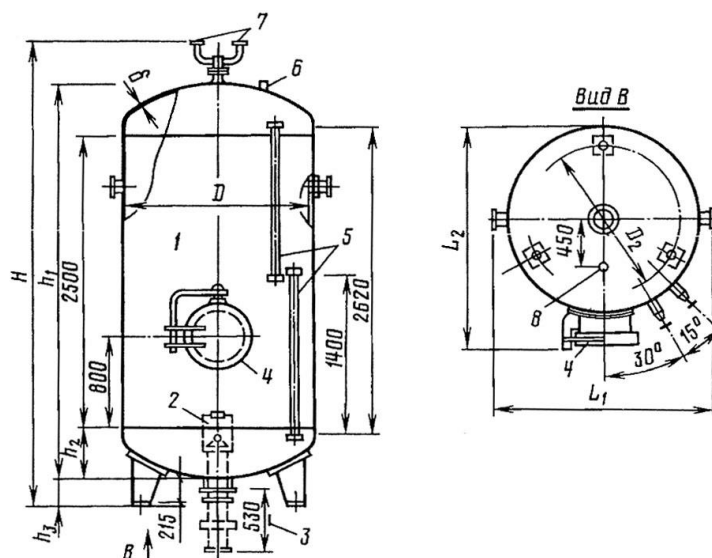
Водовоздушный резервуар: 1 – корпус бака; 2 – поплавковый клапан; 3 – минимальный размер для вывода клапана из бака со снятым поплавком; 4 – люк (лаз); 5 – указатели уровня; 6,7,8 – патрубки соответственно для установки сигнализатора уровня, присоединения предохранительного клапана, манометра и подключения магистрали сжатого воздуха, для спуска остатка
